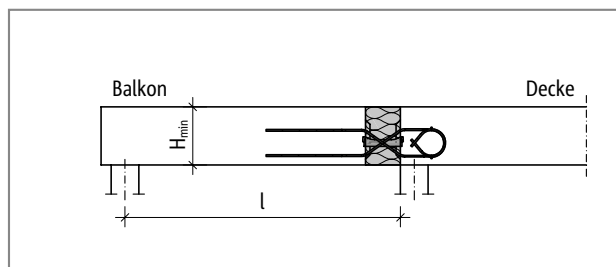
Schöck Isokorb® Typ QXT+QXT: Statisches System (Typ QXT10+QXT10 bis QXT40+QXT40)
